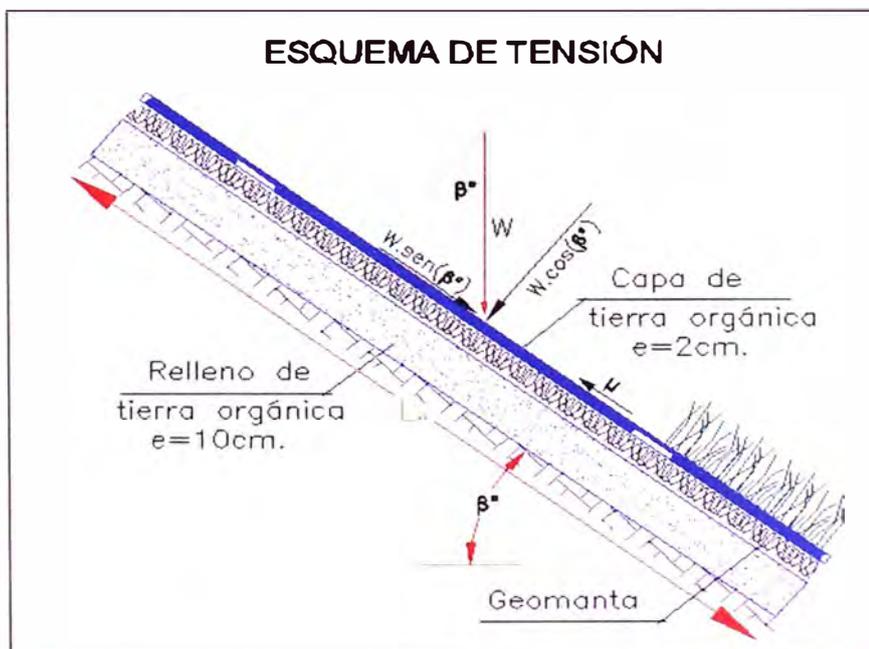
Esquema de fuerzas actuantes en el talud reforzado
